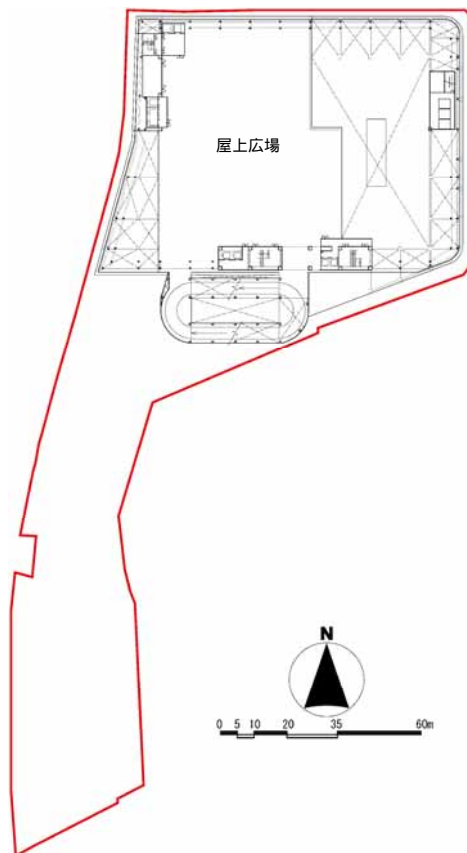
(12) 各階平面図 (R F) (変更前 : 評価書)
